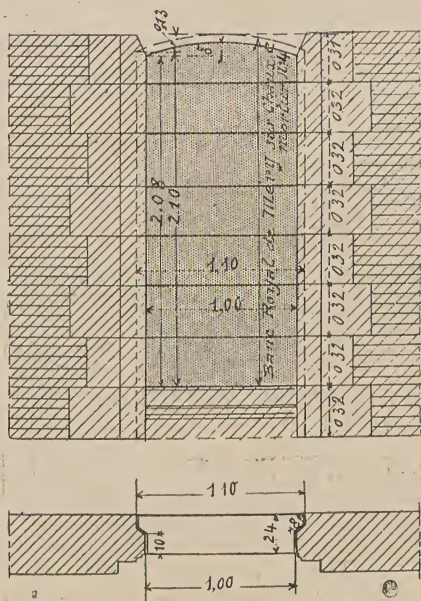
Plan et élévation sur le bouchement de baie au 3° étage.
